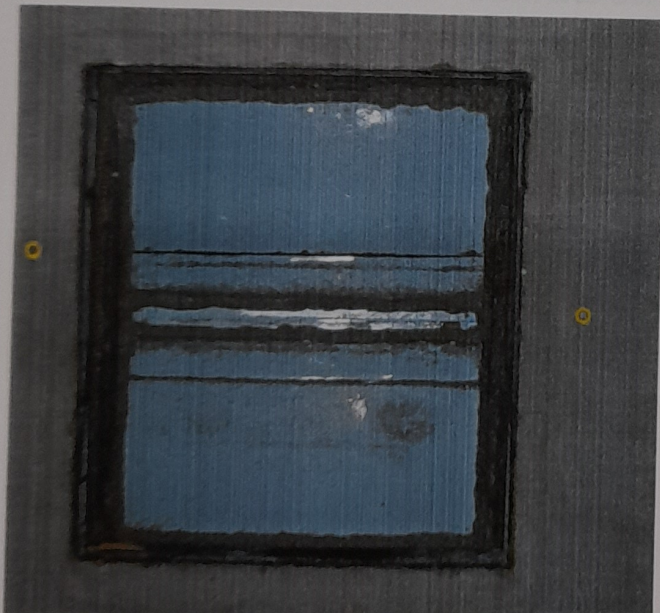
Foto des eingebauten Elementes (erstellt vom ift Schallschutzzentrum)
